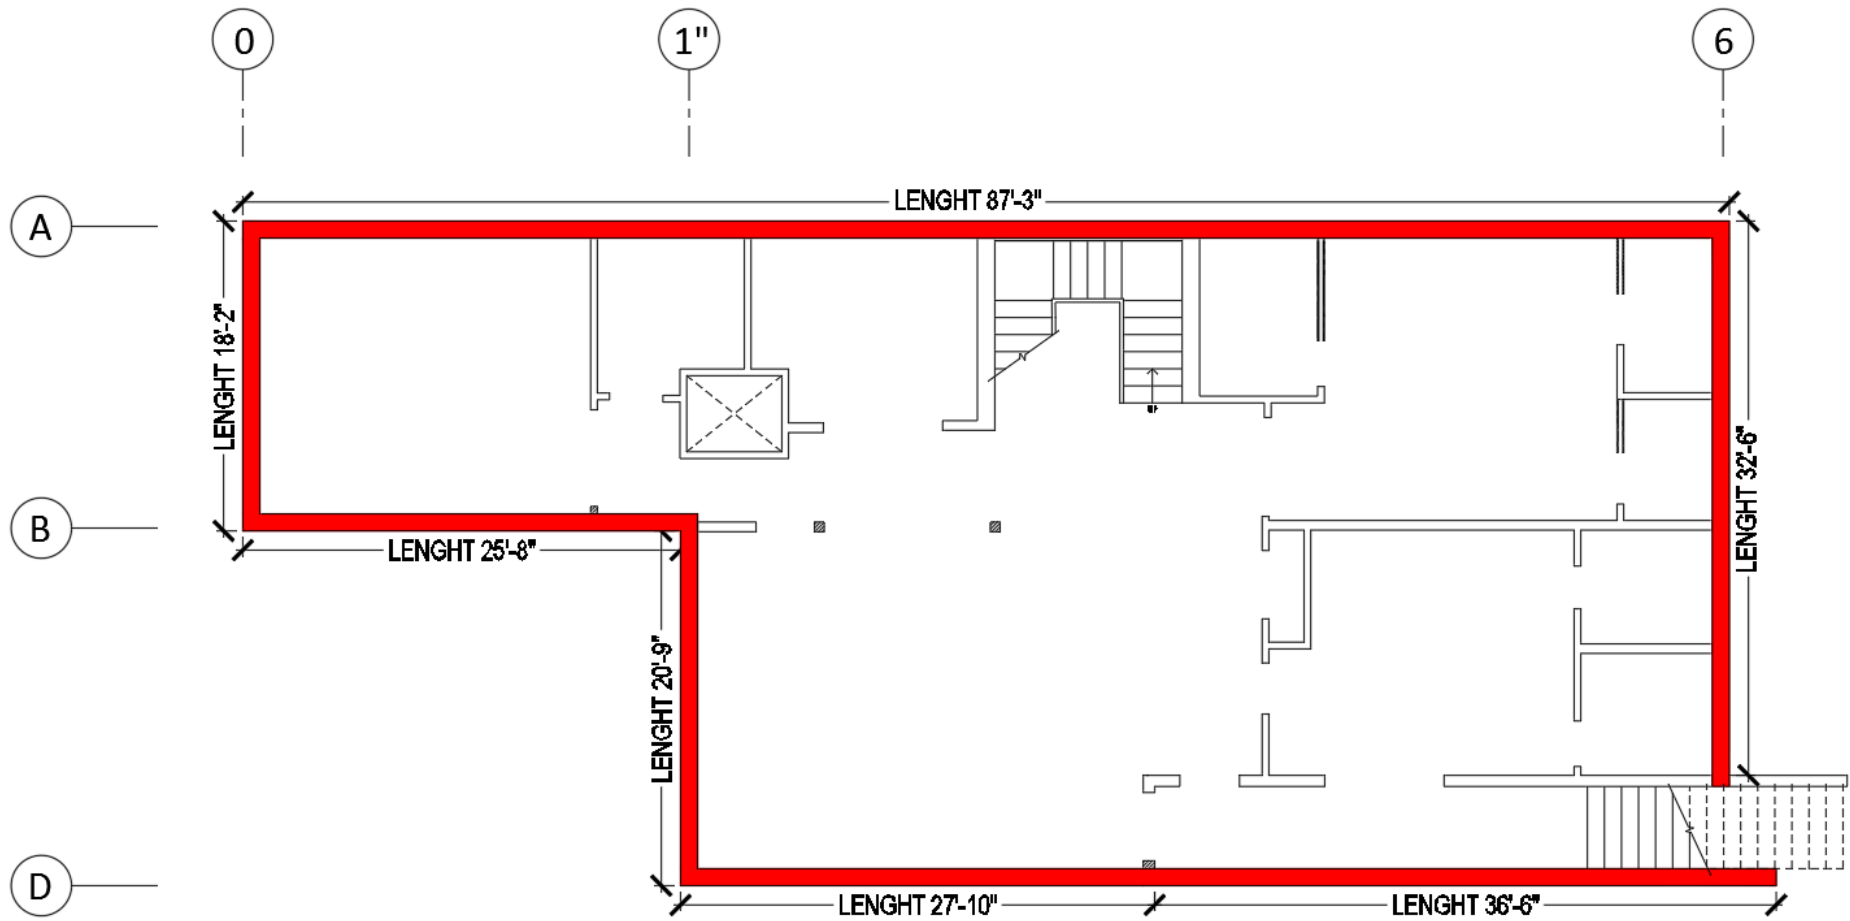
Distribución en Planta de Muros de Retención
